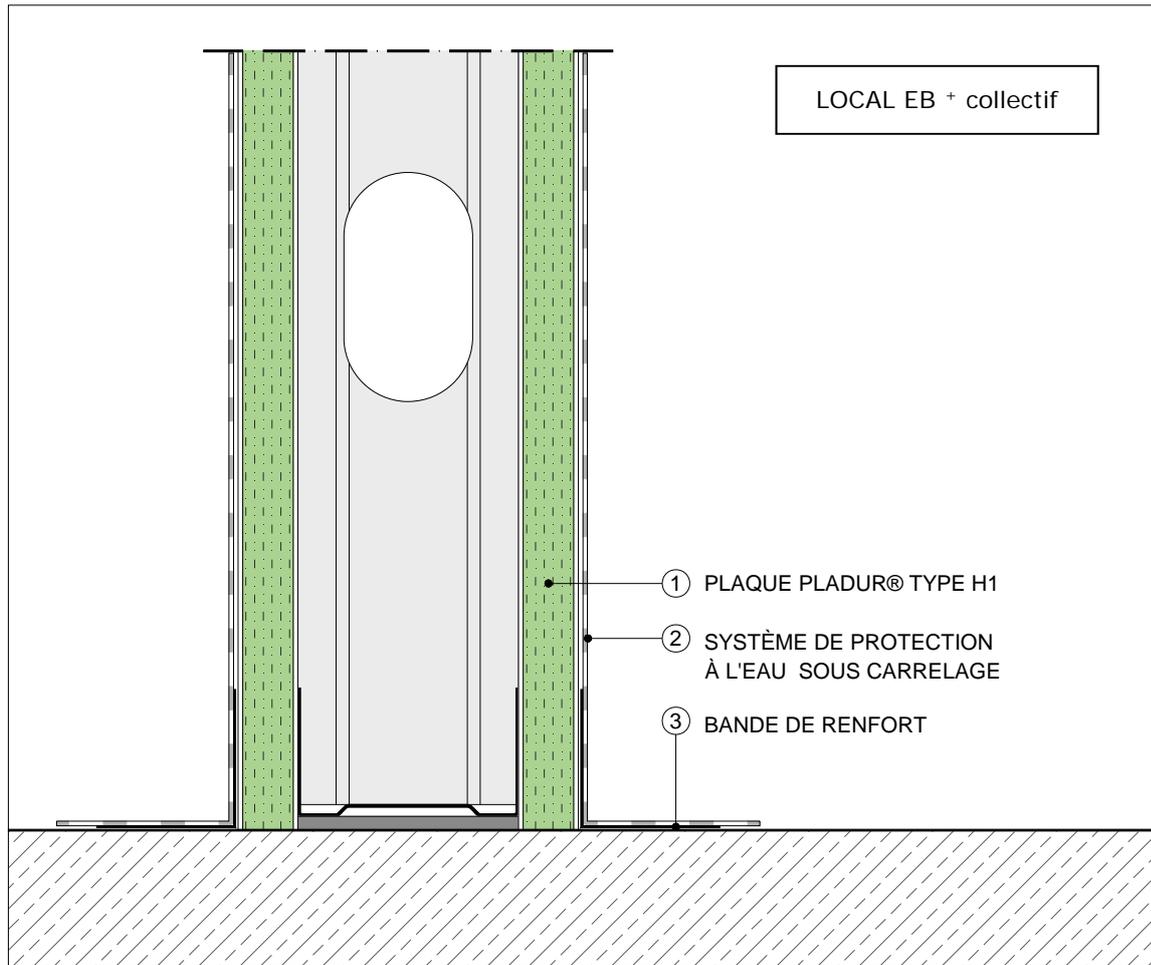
Traitement du pied de cloison dans le cas de finition carrelage – Coupe verticale
